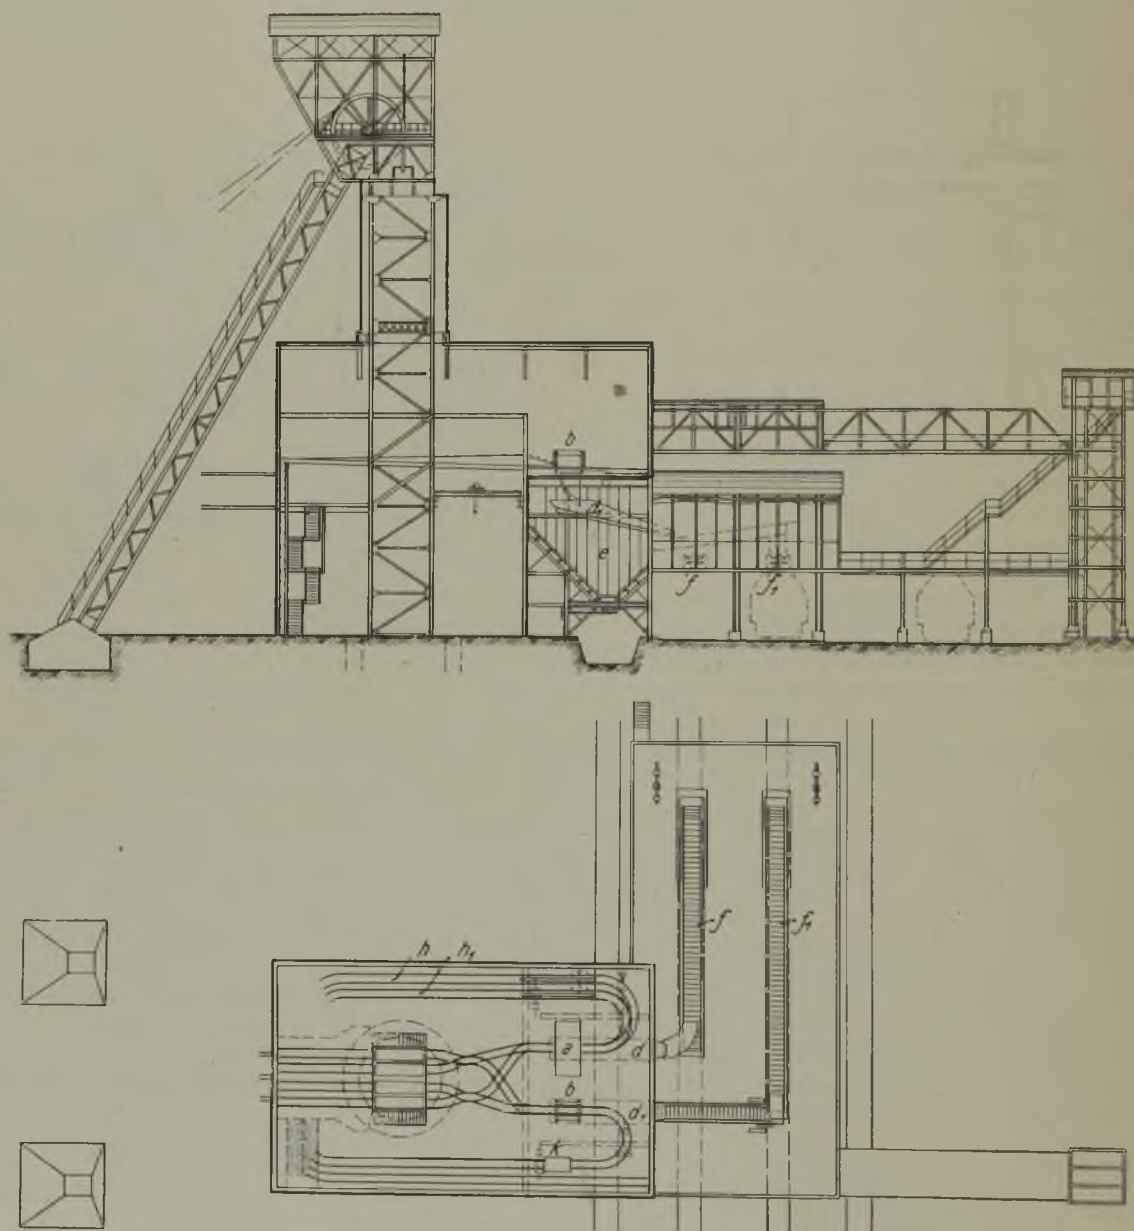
Ansicht und Grundriß des Wetterschachtgebäudes.
